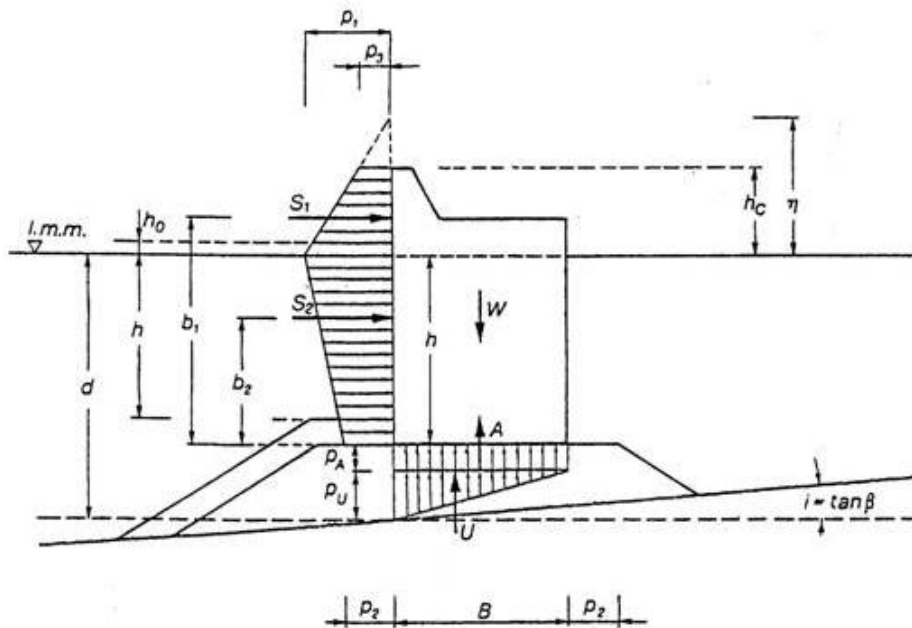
6 Schema delle forze sollecitanti una diga a parete verticale
